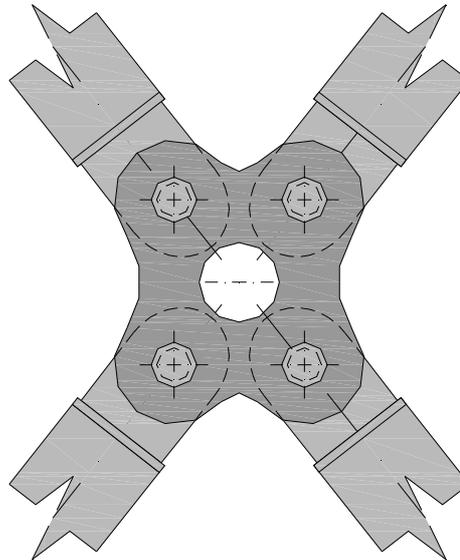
DETTAGLIO DEL COLLEGAMENTO DEI CONTROVENTI Ø193.7X11
